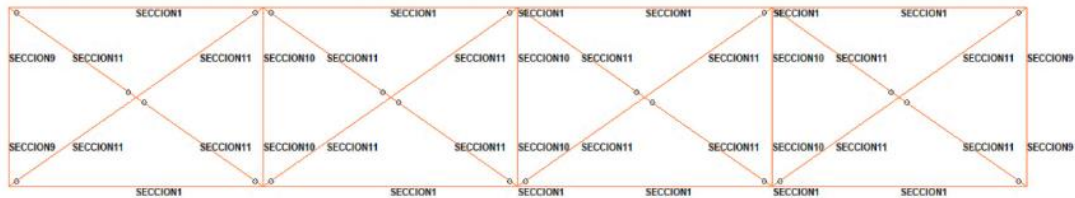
Vista en planta de la cuerda superior del modelo de la armadura con secciones
